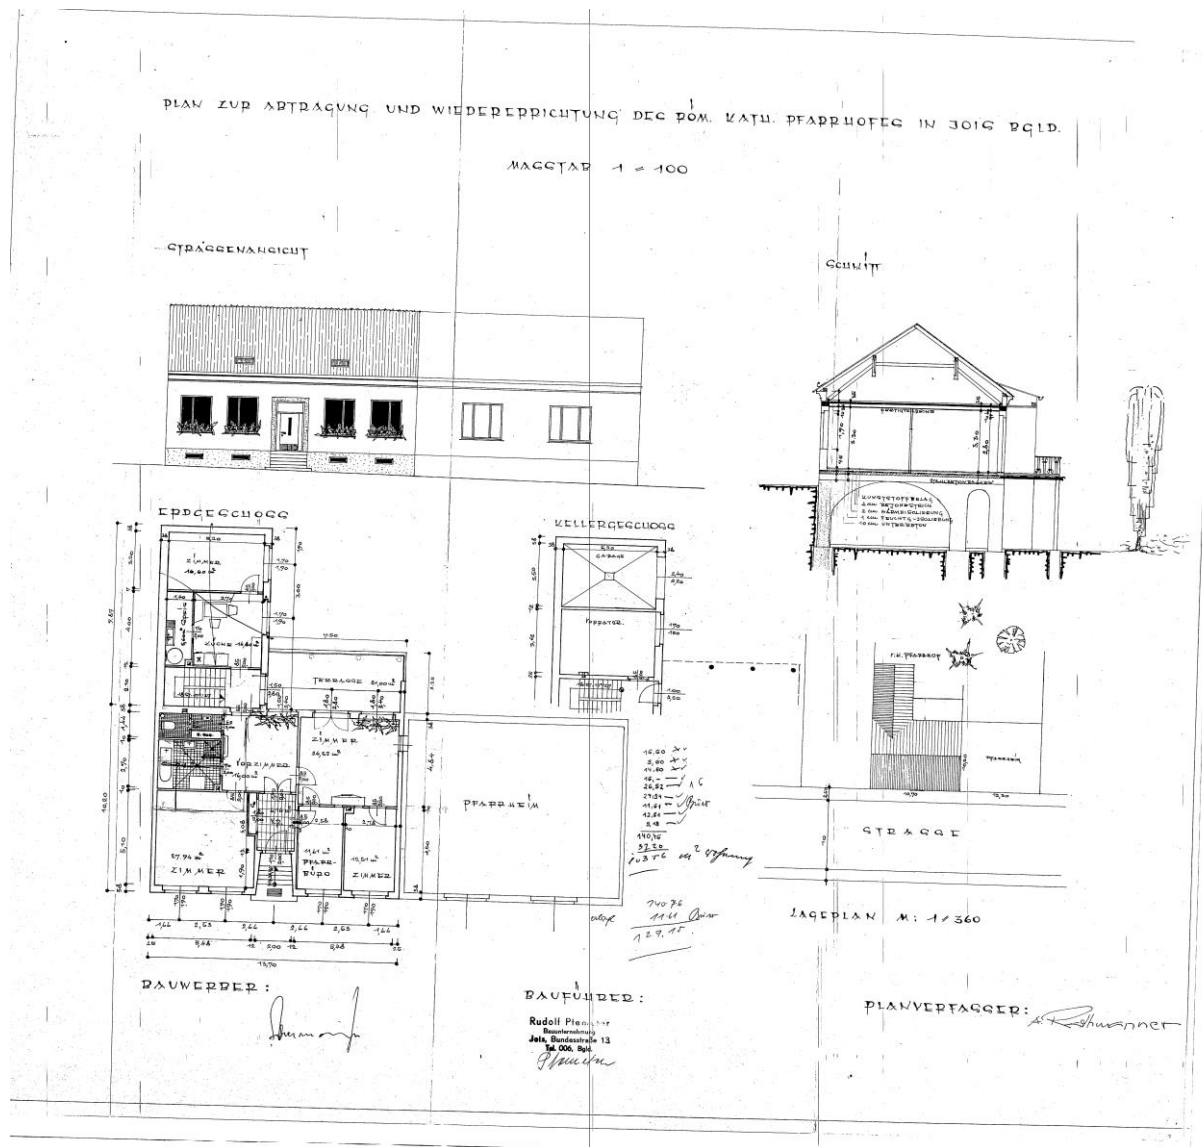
Grundriss EG, Pfarrhaus Jois.
